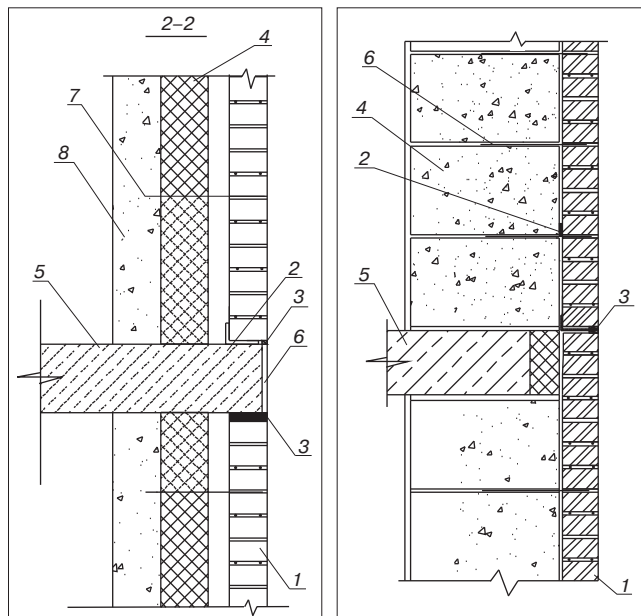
Облицовочная кладка-сечение 2-2: 1 – облицовочный кирпич; 2 – опорный уголок; 3 – деформационный шов; 4 – утеплитель; 5 – перекрытие; 6 – керамическая декоративная вставка; 7 – анкер; 8 – внутренняя стена
